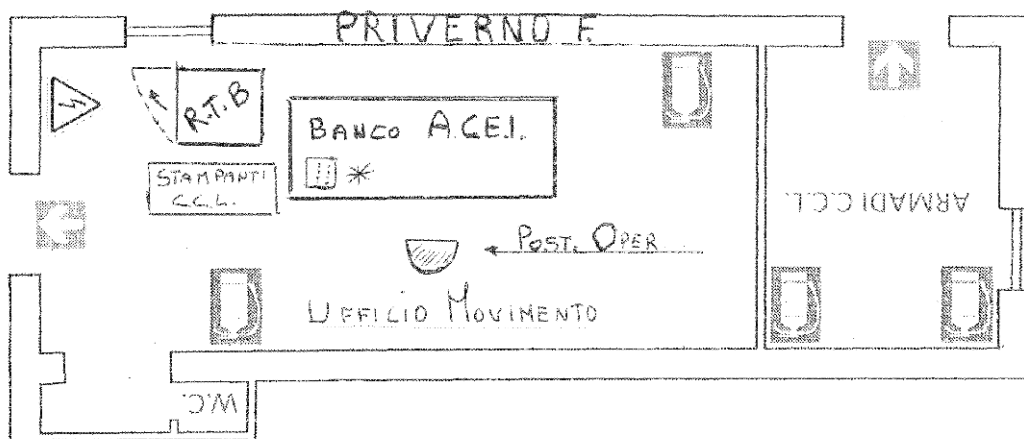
Schema planimetrico dell'Ufficio Movimento di Priverno - Fossanova
